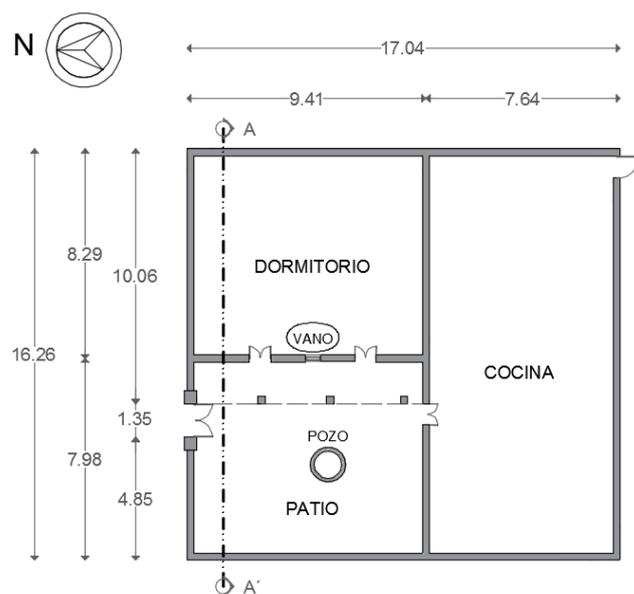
Vista en planta de vivienda vernácula, caso 1, en Santa María Asunción, Hidalgo.
